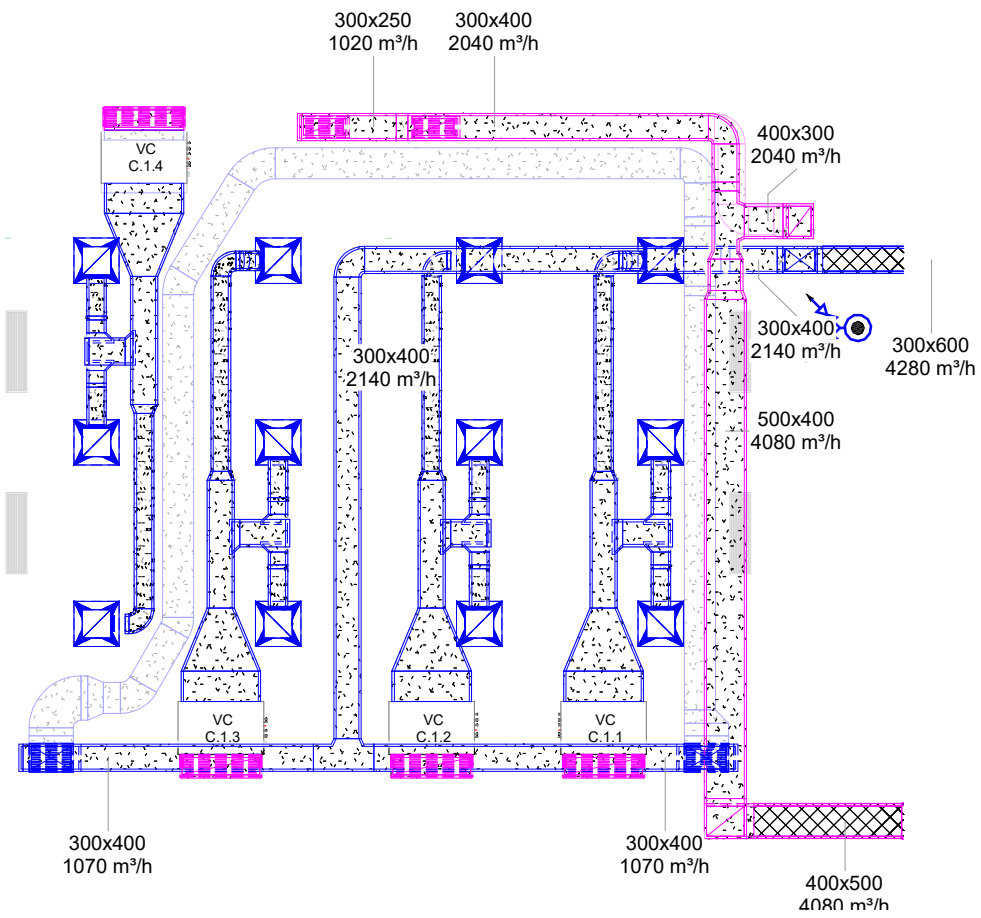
Seção 2.4 da planta geral do traçado das condutas na mezzanine à escala 1:100.
